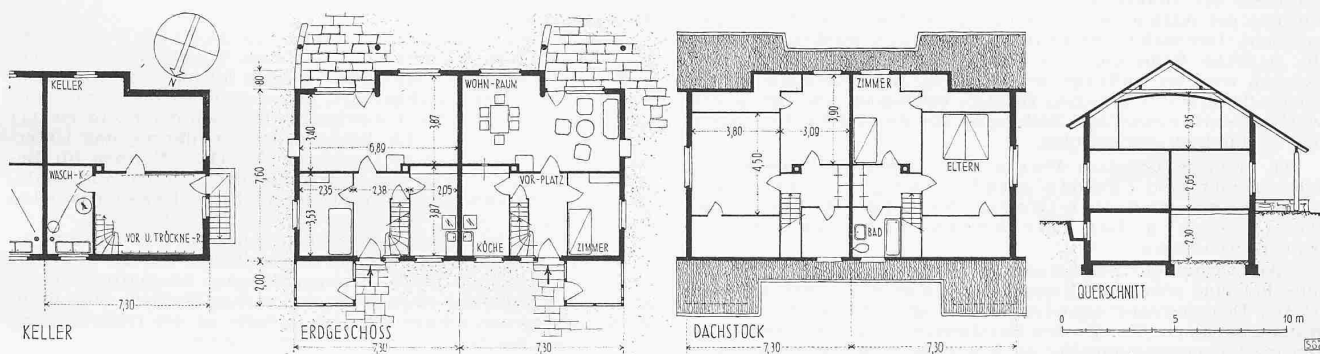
bis 13. Siedlung «Im Wiesental», Kilchberg. Arch. ALFRED BINGGELI, Zürich-Kilchberg. — Grundrisse und Schnitt 1 : 300, Haustyp B
